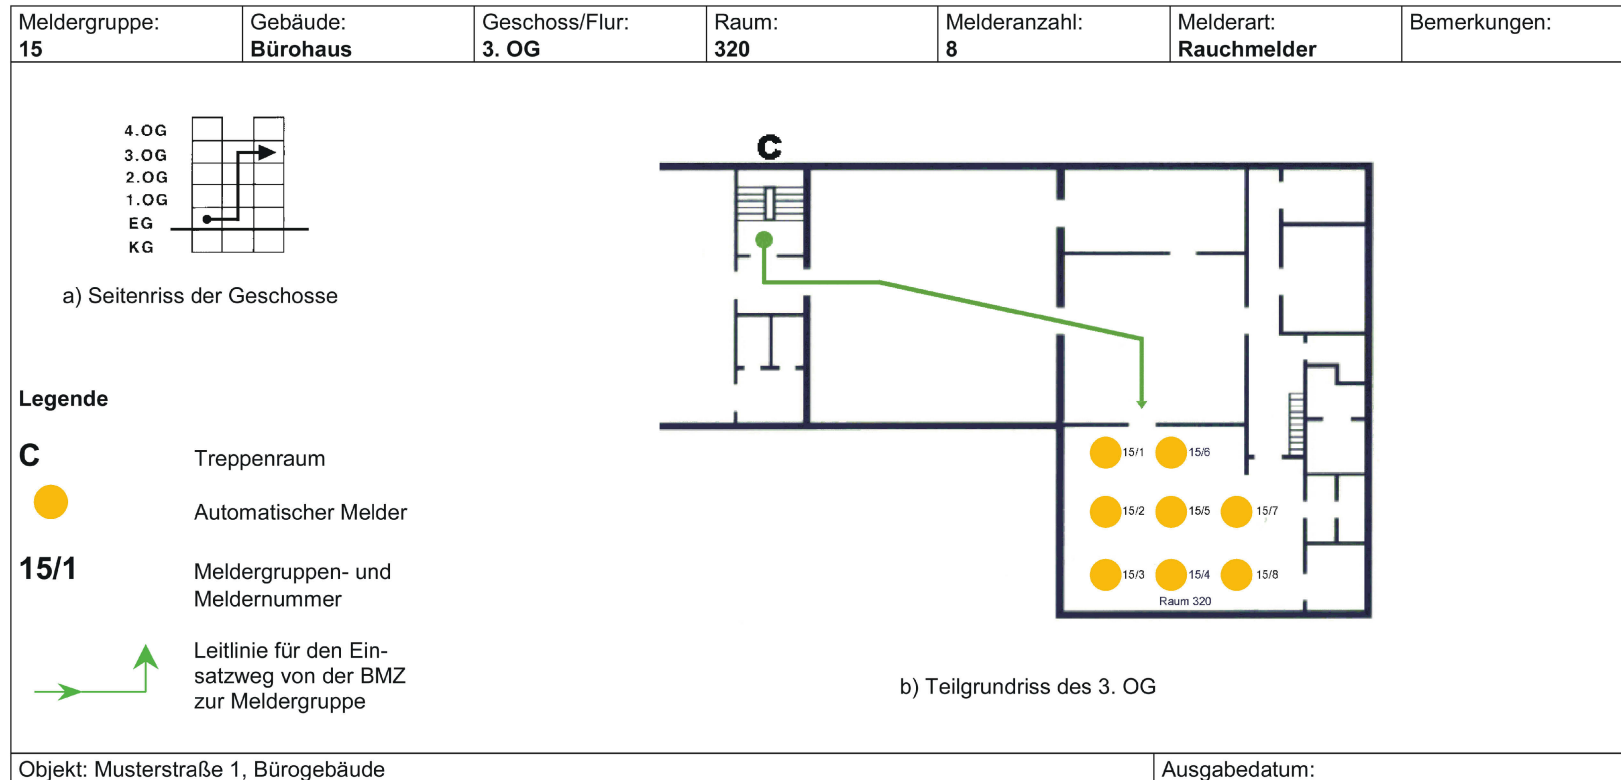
Darstellung einer Feuerwehr-Laufkarte: Rückseite – Meldergruppen-Detailplan im 3. OG als Teilgrundriss, mit Seitenriss der Geschosse und Legende
